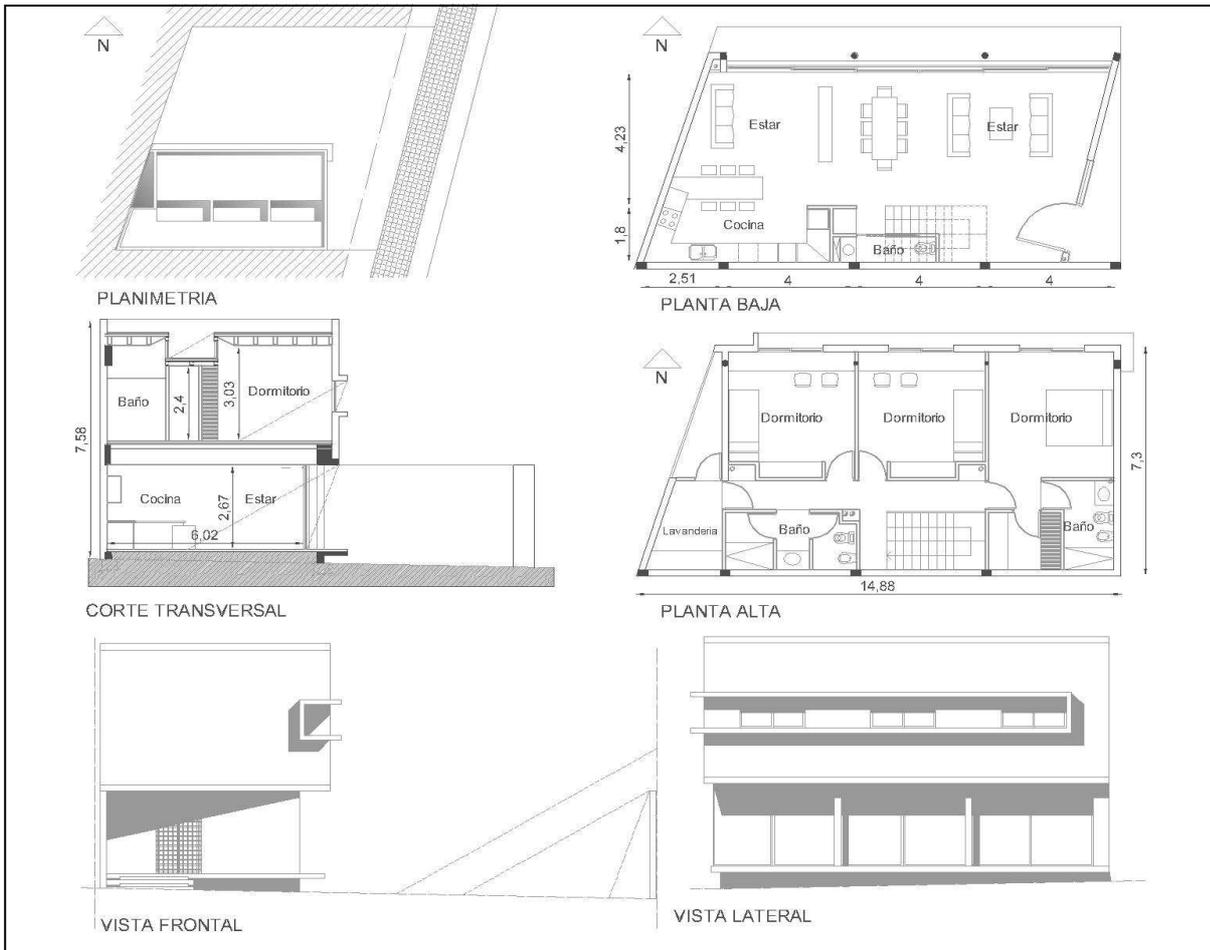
Planimetría, plantas, corte y vistas de la vivienda analizada.
